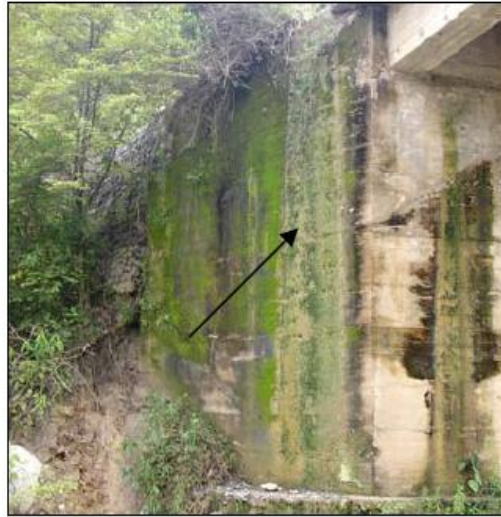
Evidencia de manchas de óxido en la superficie del concreto. Puente sobre el Río Quindío.
